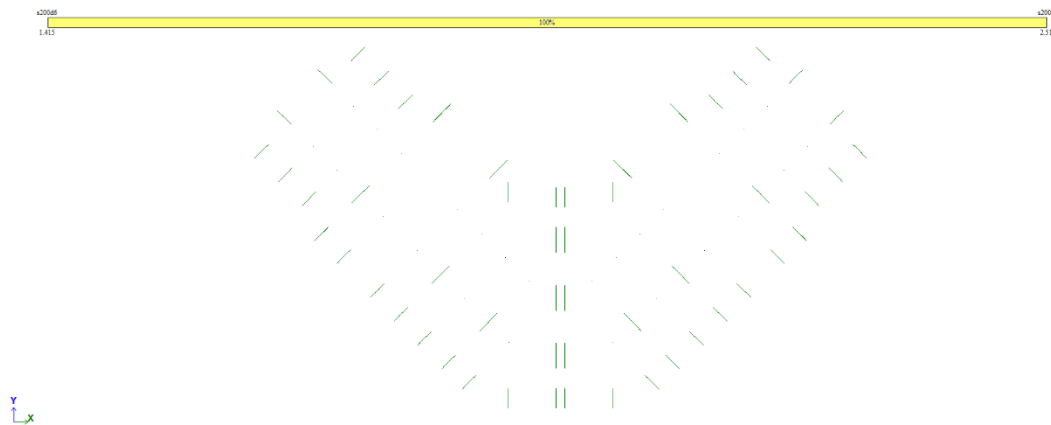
Площа арматури пілонів на 1 м. п.
